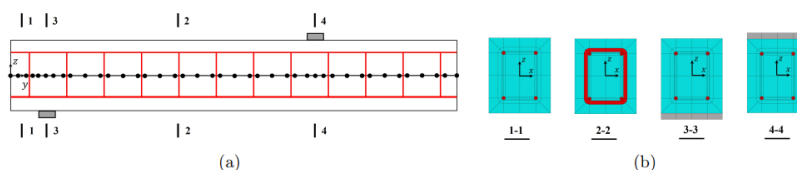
(a) Discretização de EF em elementos viga e (b) discretização da secção transversal para a viga de BA.
